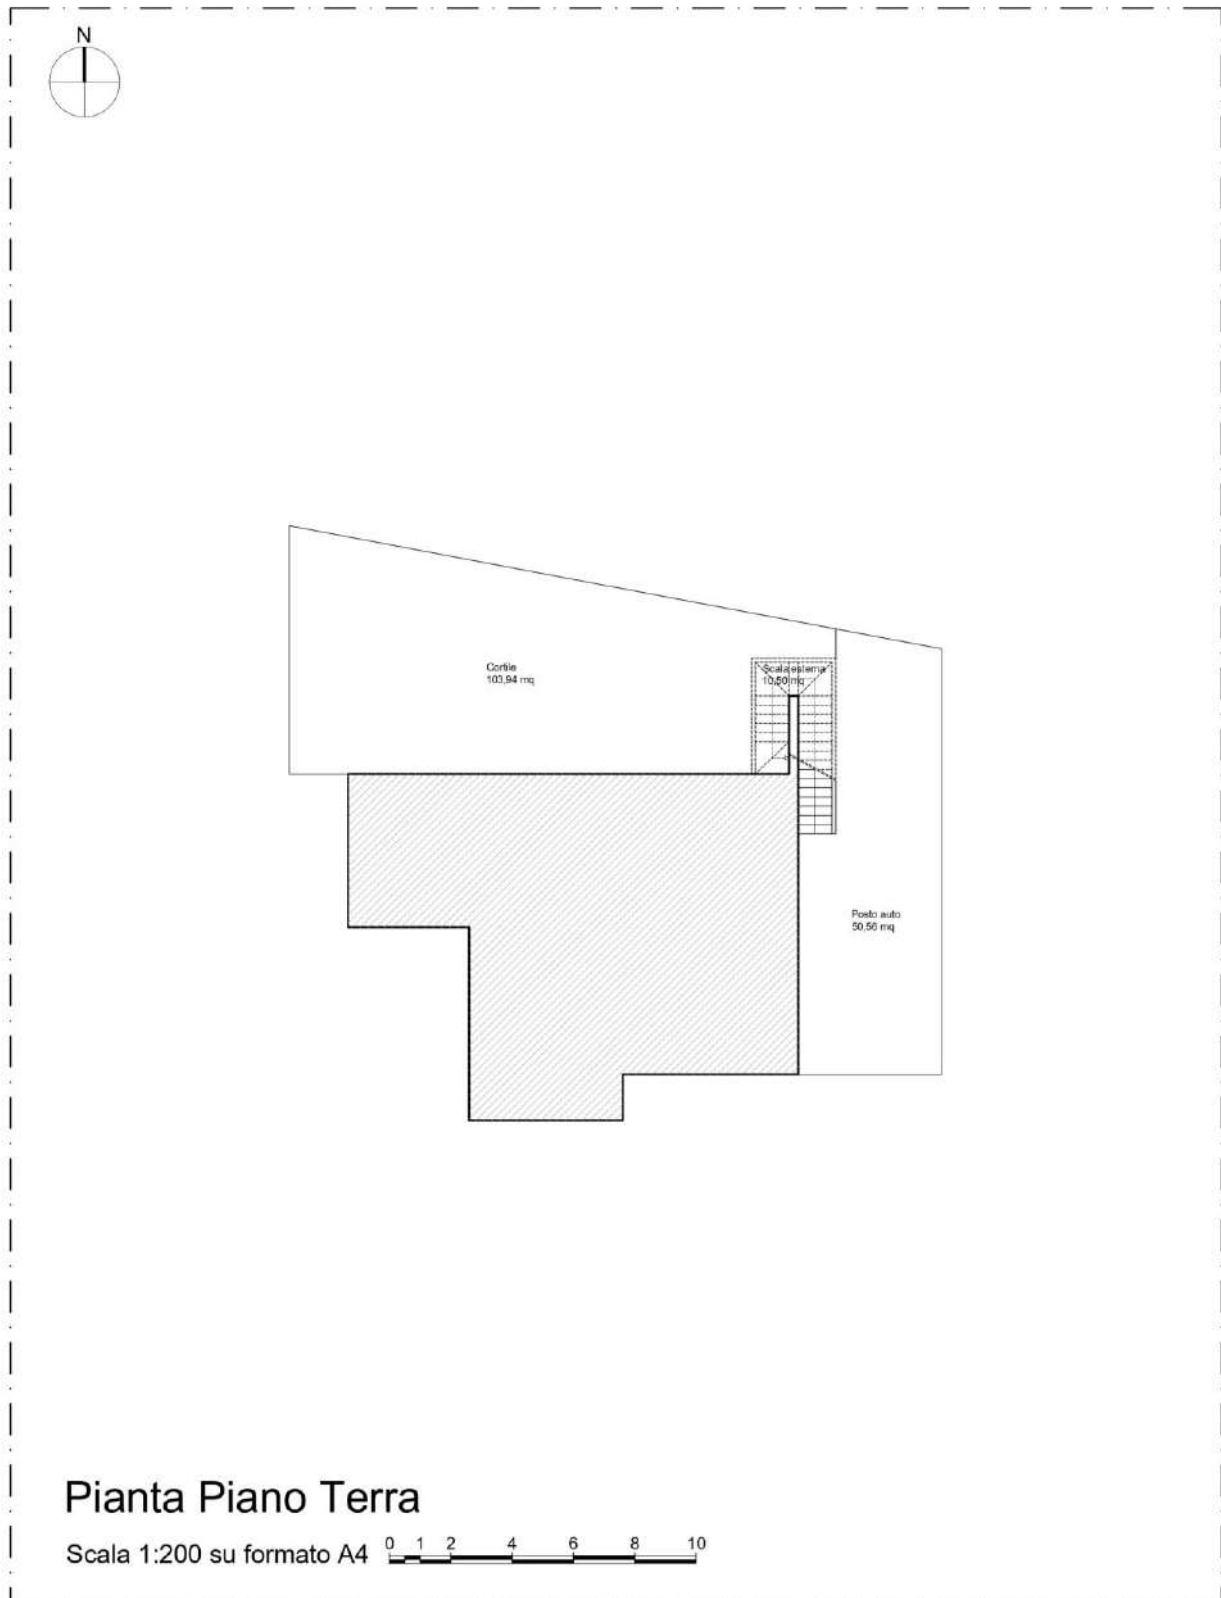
Planimetria dello stato di fatto – Pianta Piano Terra
